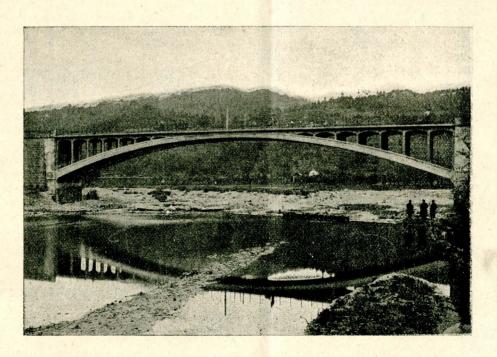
Ponte sulla Bormida presso Millesimo.
